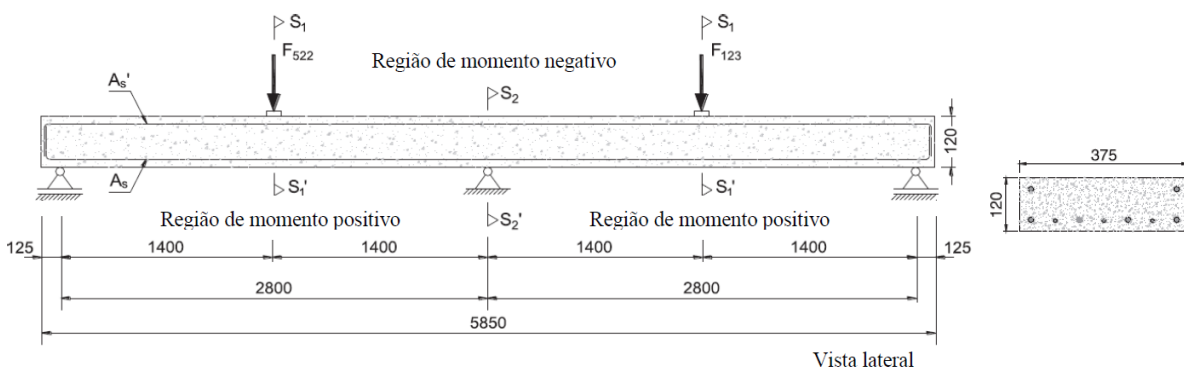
Geometria das faixas de laje ensaiadas por Dalfré e Barros (2013).
